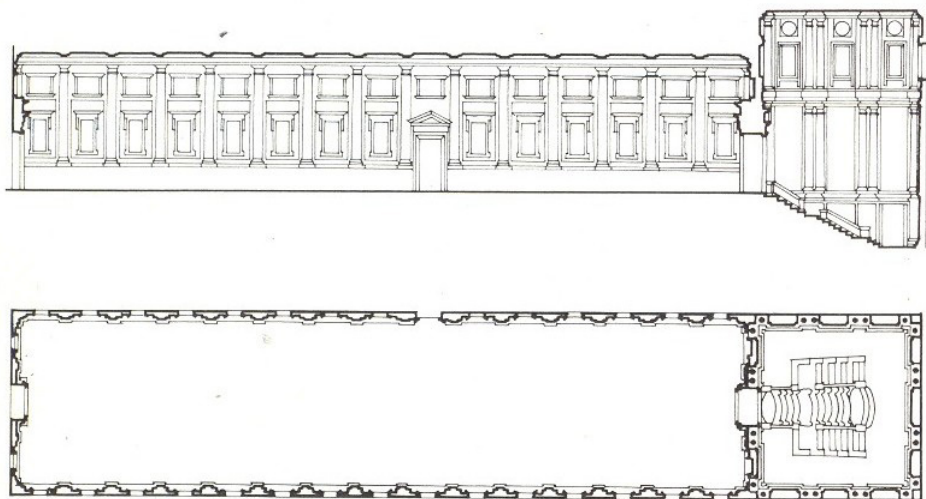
Corte e planta da Biblioteca Laurenziana em Florença, Itália.
